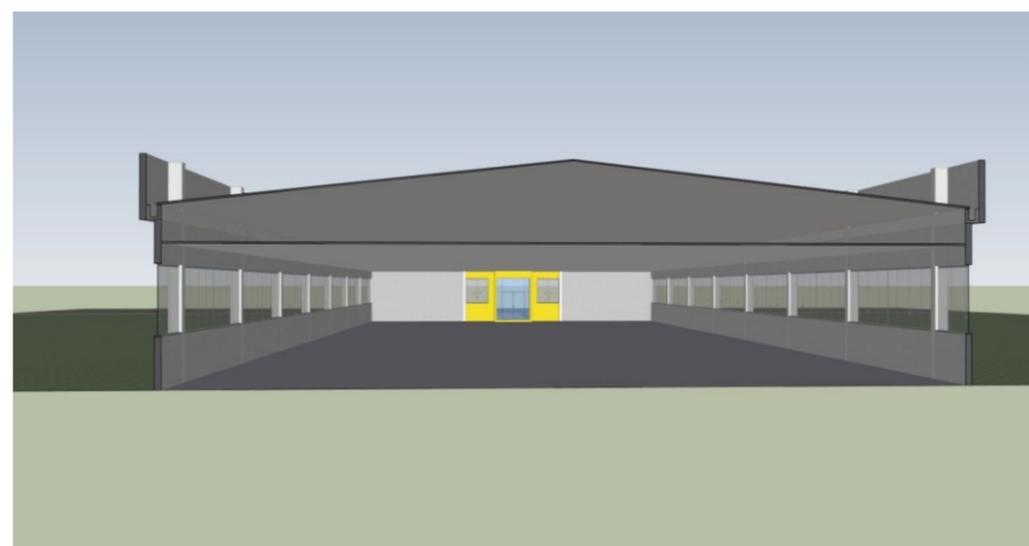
IMAGEM CORTE PAVILHÕES - CAMPUS PR & RS
